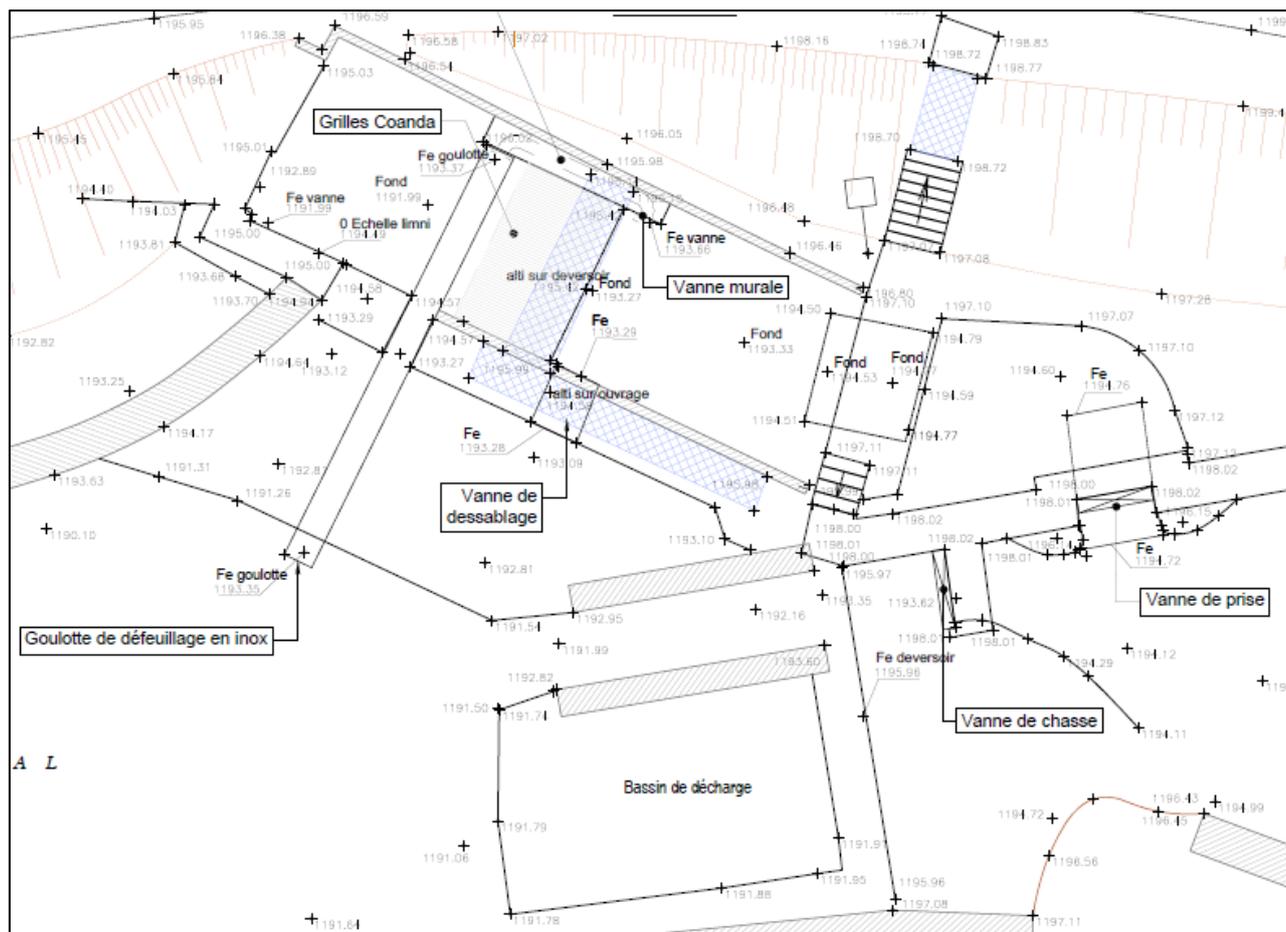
Plan détaillé en vue de dessus de la prise d'eau de la Ribérolle basse
